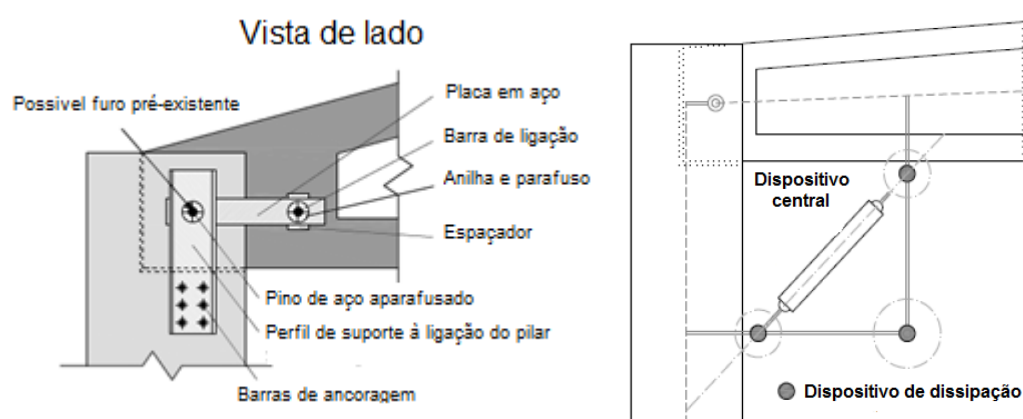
Exemplos de intervenção da ligação entre viga e pilar [1]
